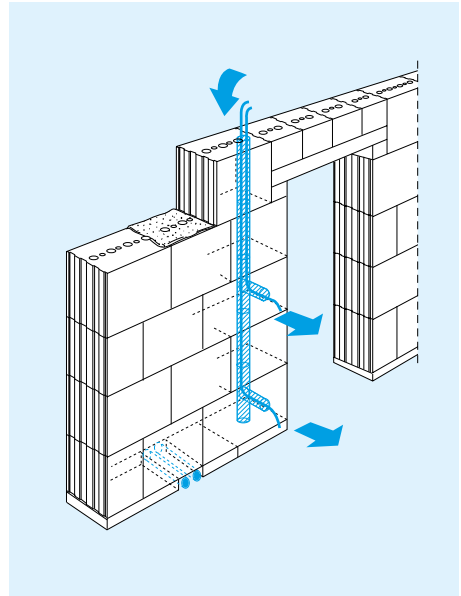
Die Leitungsführung kann innerhalb der Wand erfolgen. Voraussetzung: Steine mit durchgehenden Installationskanälen.
